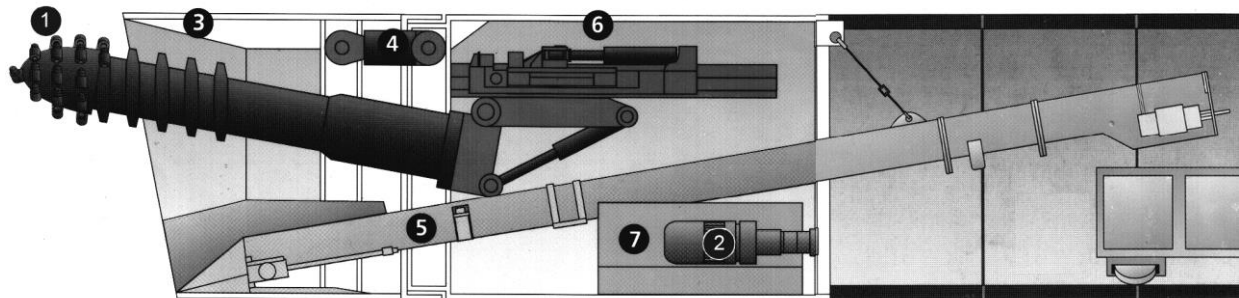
Щит із фрезерним робочим органом: 1 – фрезерний робочий орган; 2 – щитовий гідроциліндр; 3 – ножове кільце; 4 – гідроциліндр управління; 5 – транспортер; 6 – оболонка щита; 7 – гідроагрегат
